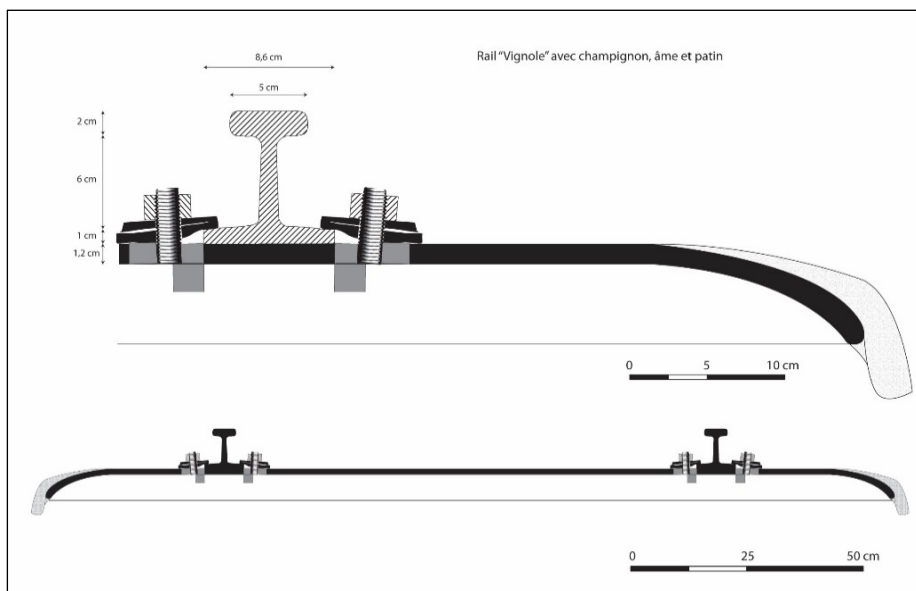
Saint-Benoît. Coupe longitudinale d'une des voies sur traverses métalliques de type Vignole (DAO F. Gerber, Inrap)
